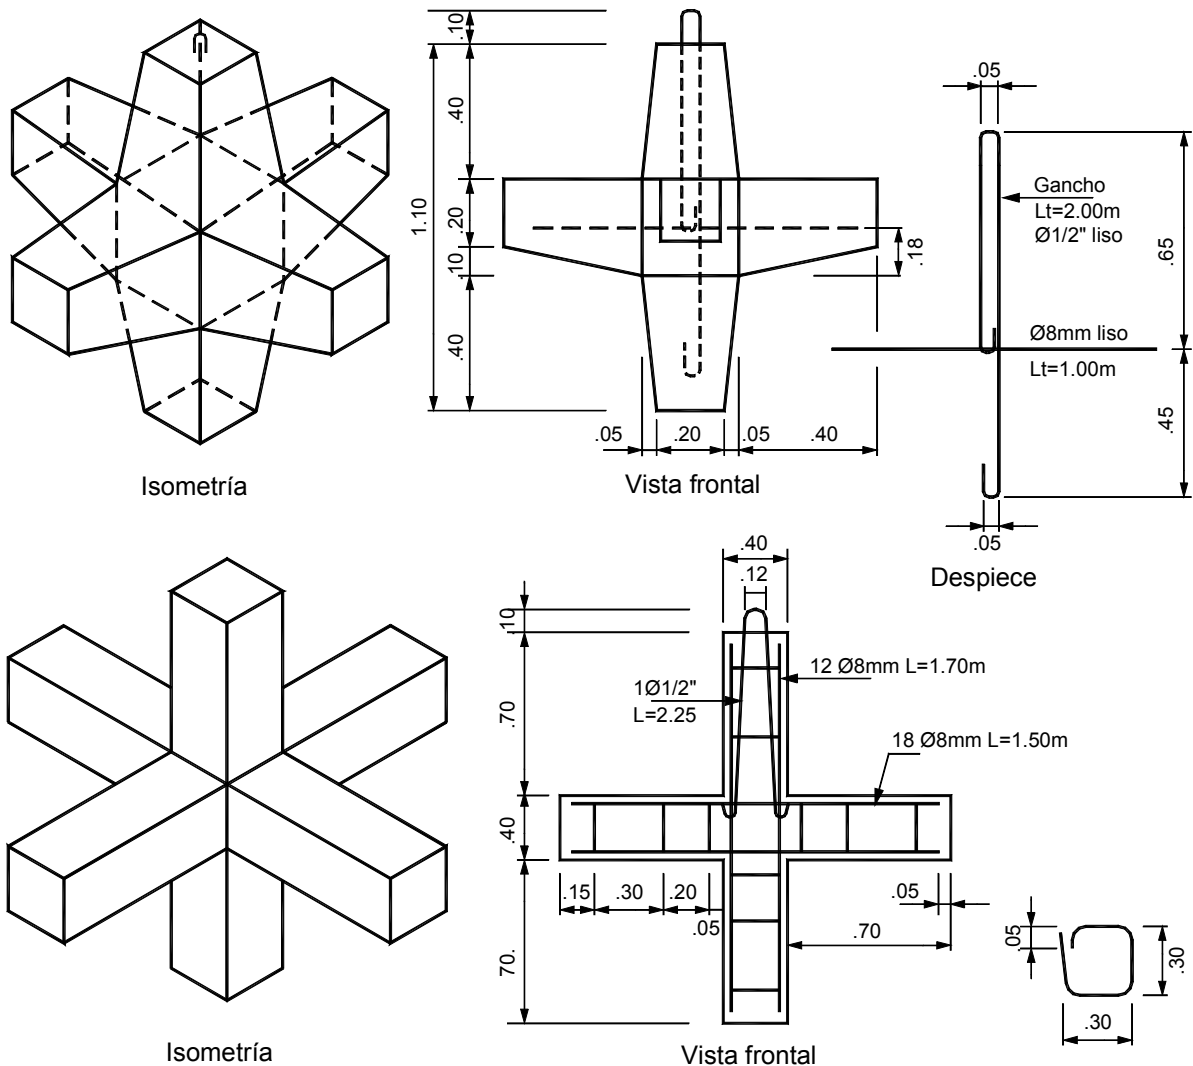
Detalles de diseño de hexápodos en concreto armado.
